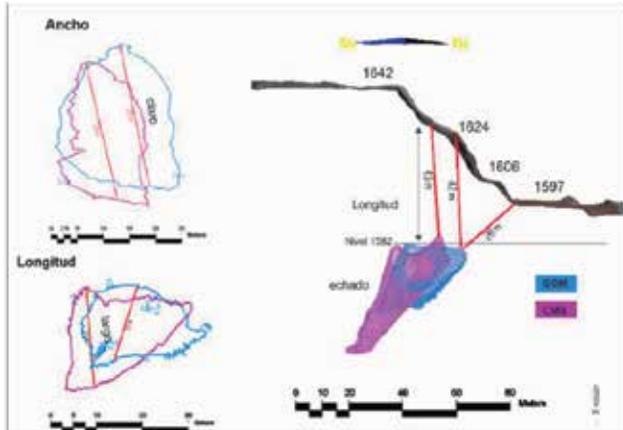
Vista en sección y planta de los dos barrenos ejecutados
